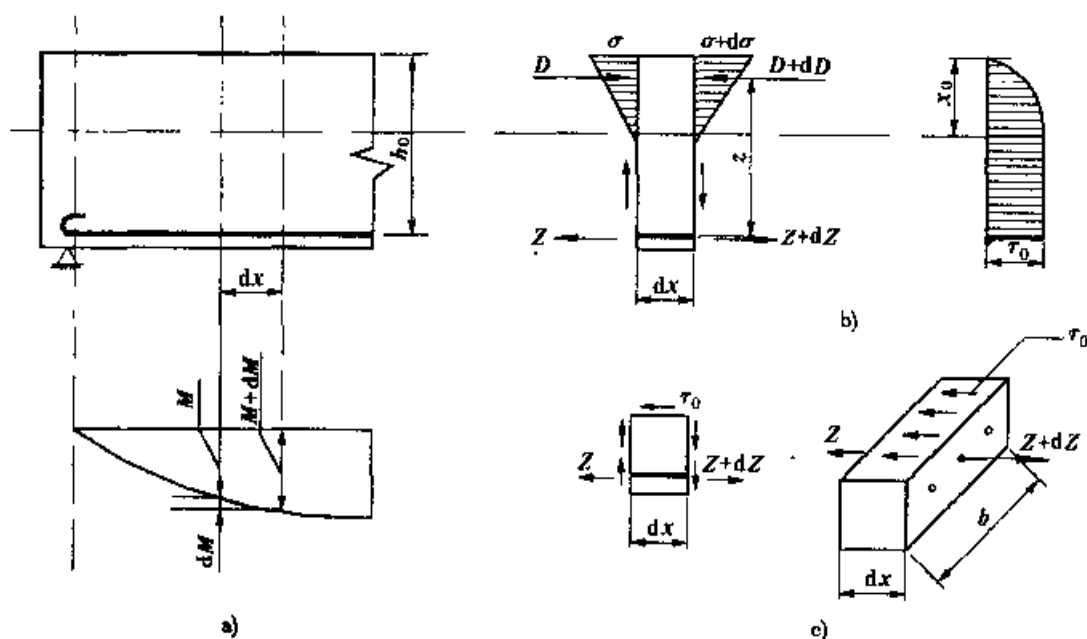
钢筋混凝土梁段和分离体的受力情况
